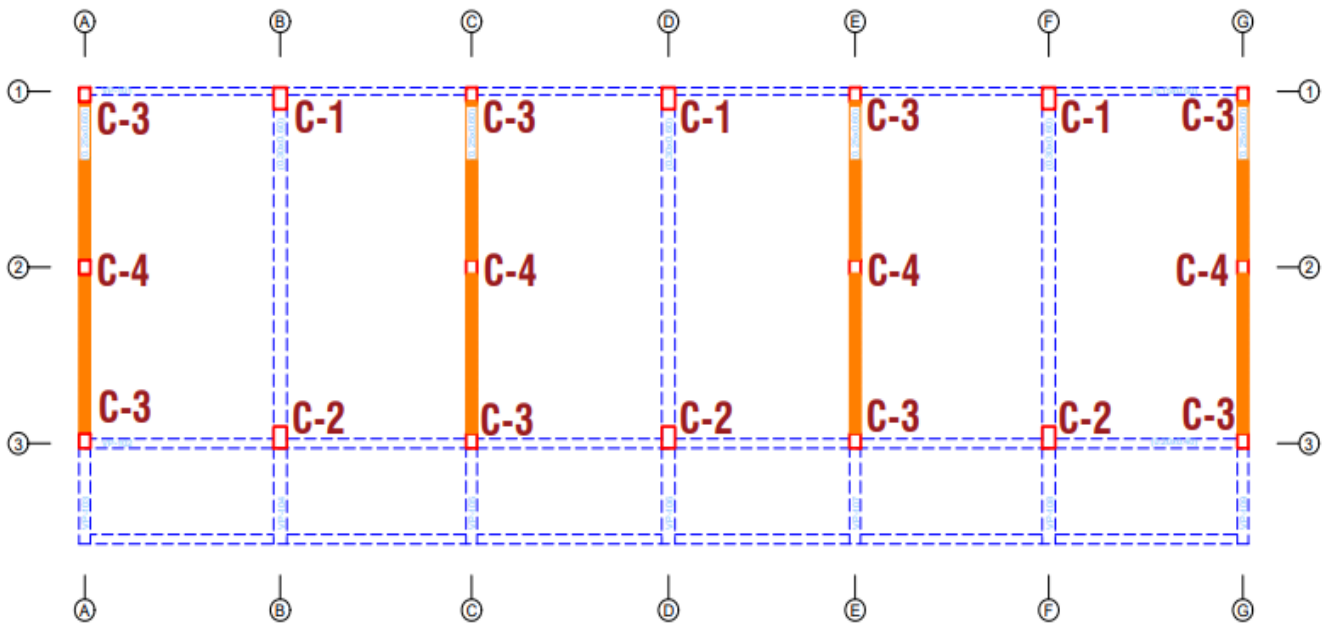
Arranque de acero exterior en columna de pórtico Bloque 1
